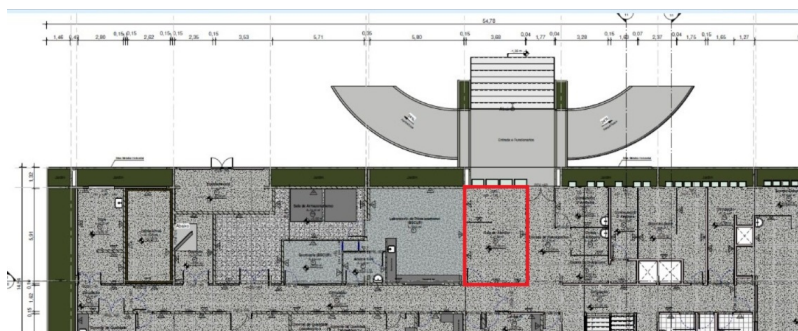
Planta baixa do bloco A, Térreo, da FHB, onde se localiza a sala de aférese (área destacada em vermelho).
